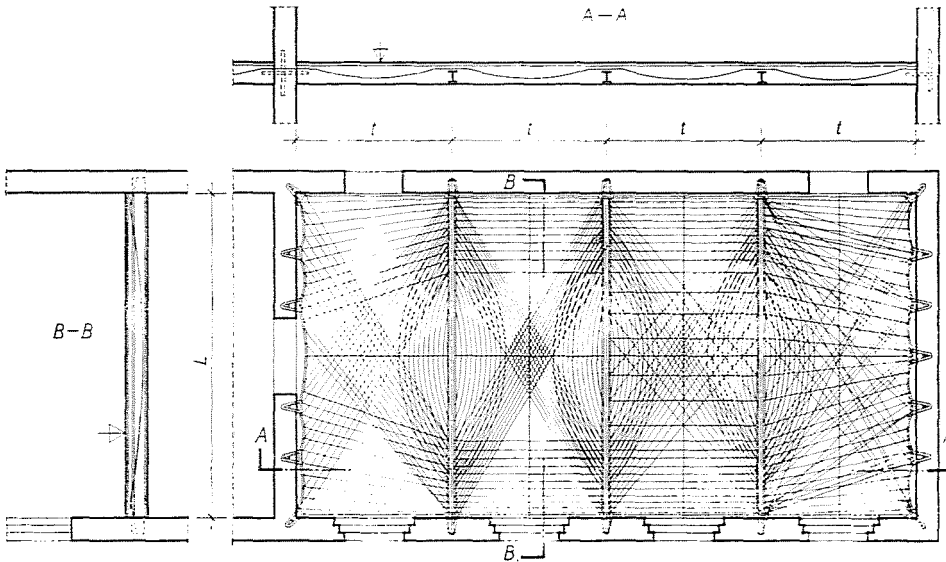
Disposition caractéristique des éléments en acier du plancher type Mâtrai (vue en plan, coupes)
